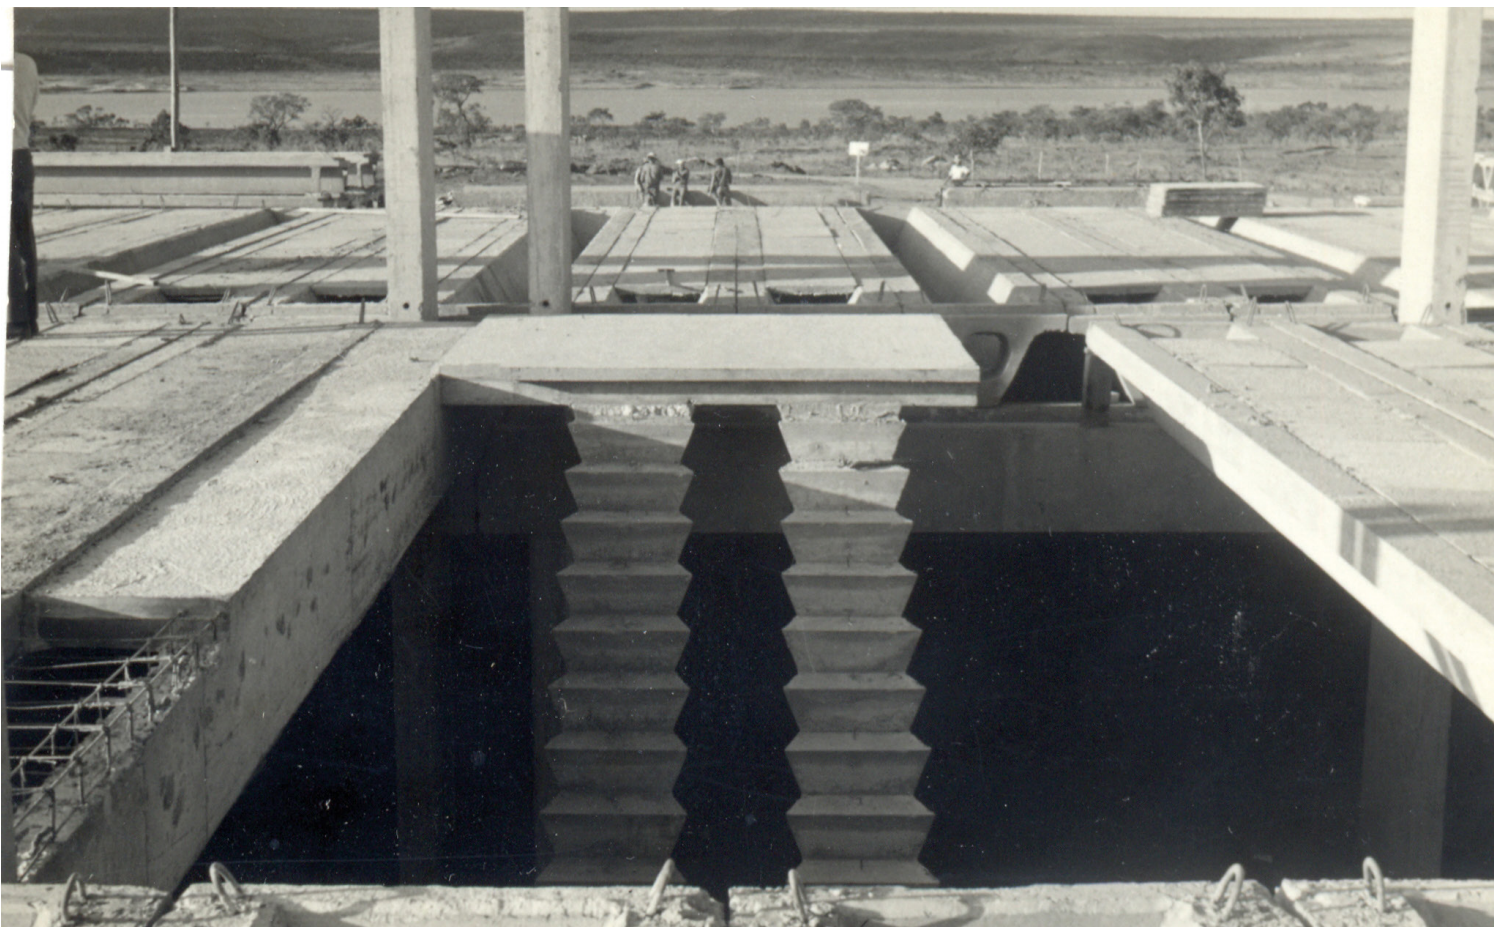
Vista do pavimento térreo. Montagem da escada de acesso ao subsolo.
